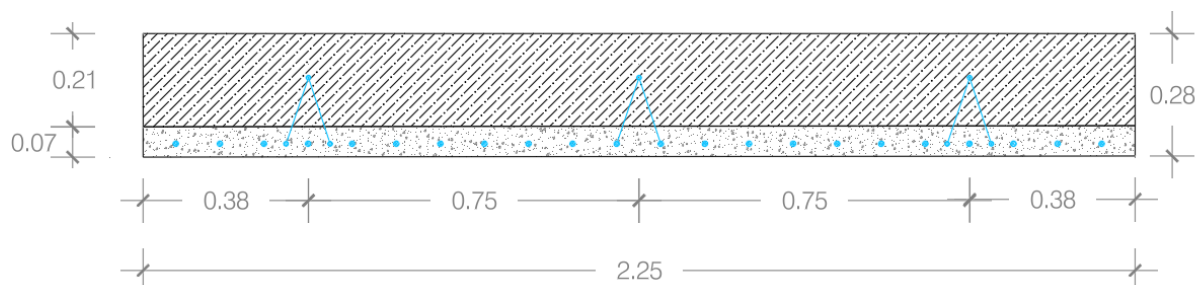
Solução da pré-laje maciça simplesmente apoiada
